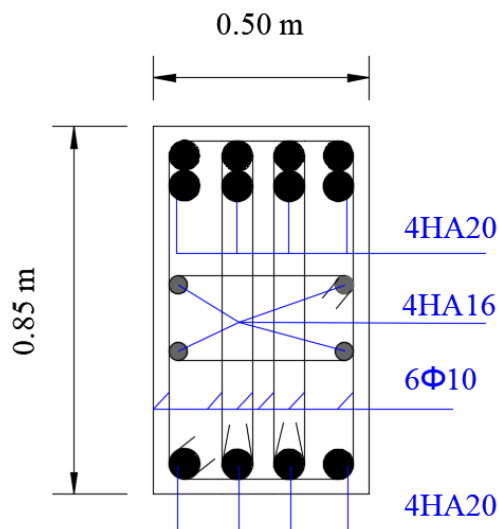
ferrailage de la poutre principale (50×85) sur appui
